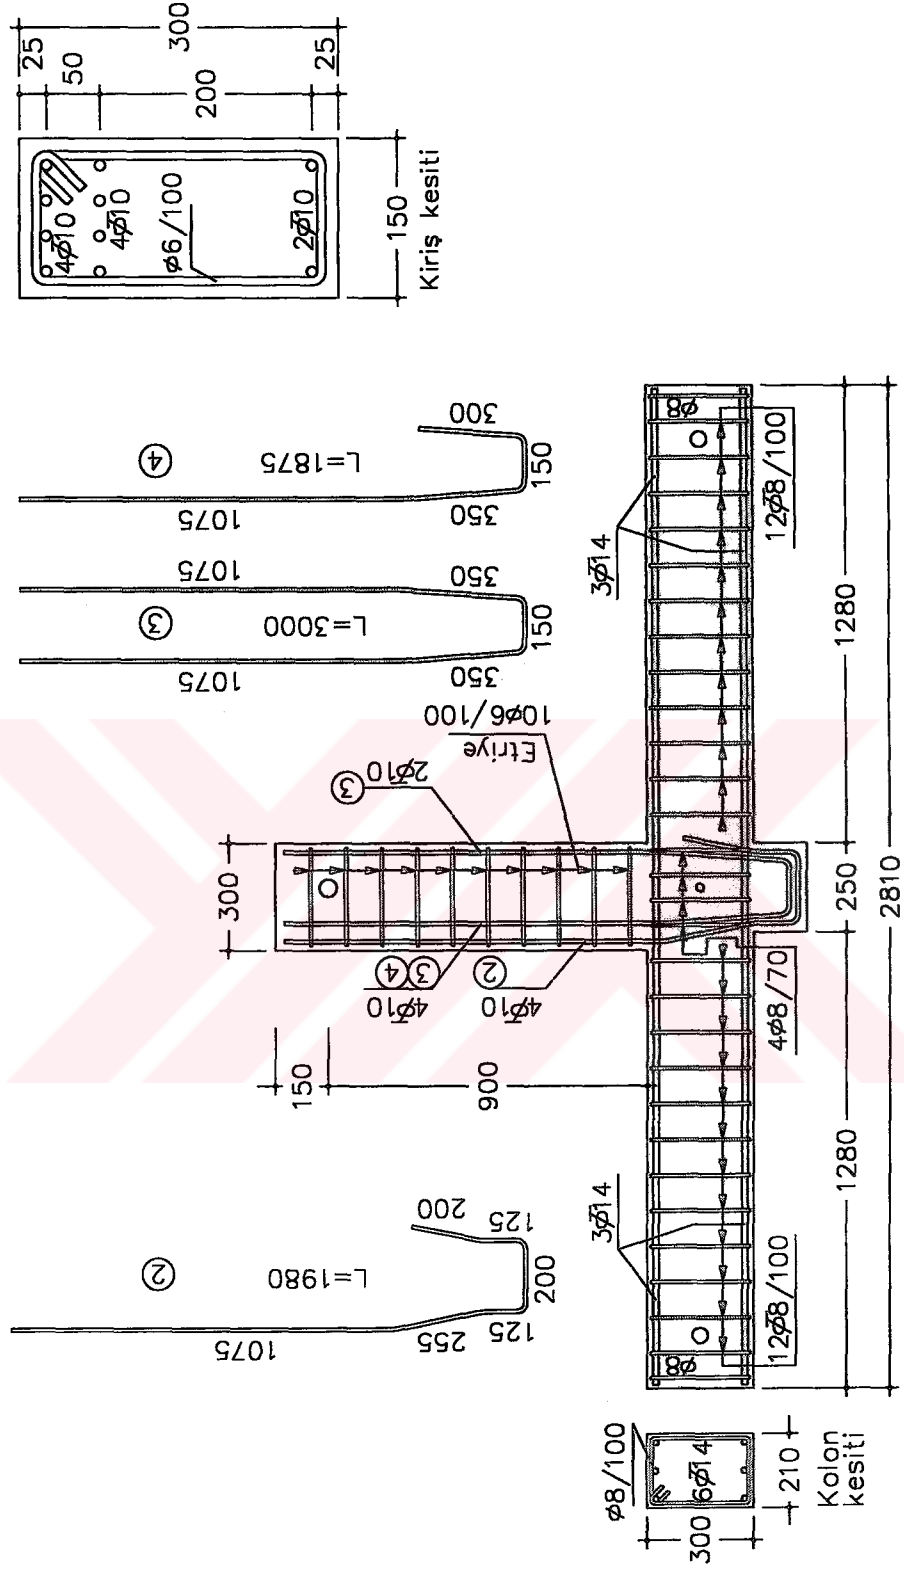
RC5 elemanın boyut ve donatı detayı
